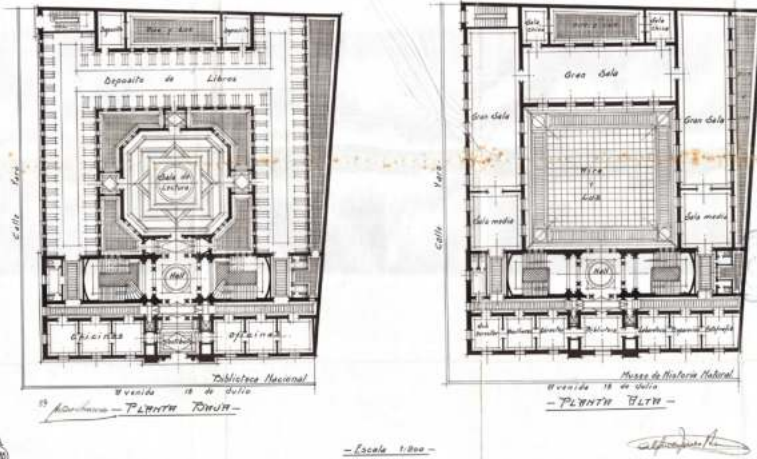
Planta baja y primer nivel del proyecto de Alfredo Jones Brown para BN y museos del Estado. C. 1909. Archivo del MTOP.
